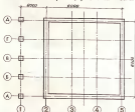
План фундаментов. По осям А, Д, 2 и 3 — ленточный фундамент под кладку стен основного дома, по осям 1 — столбчатый фундамент под веранду. Если брус обвязки достаточно массивный, то столбы по осям Б и Г можно не делать или поставить четыре столба с интервалами по 2000 мм.
